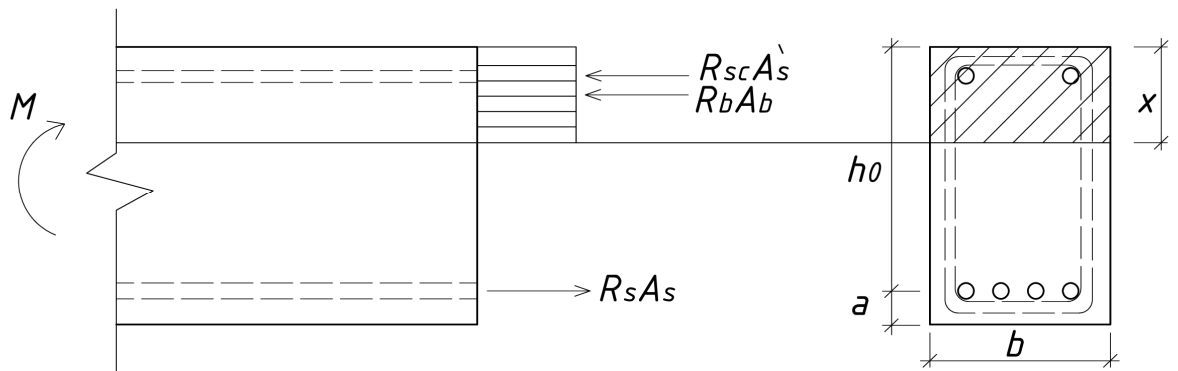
Эпюра напряжений в сечении железобетонной балки по СП 63.13330.2012
